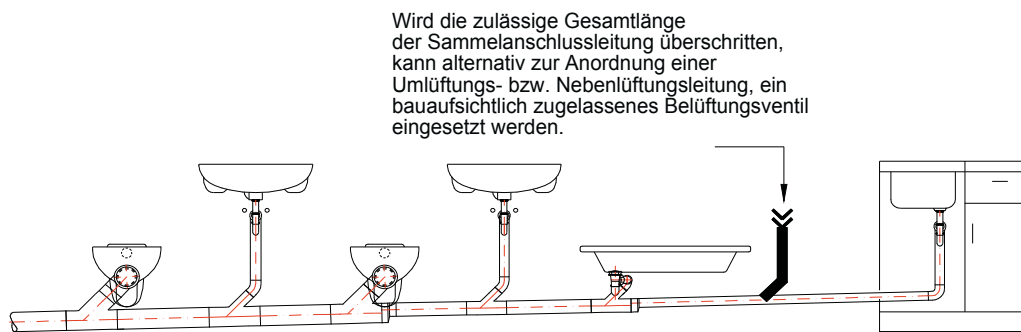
Einsatzmöglichkeit eines Belüftungsventils bei einer längeren Sammelanschlussleitung
